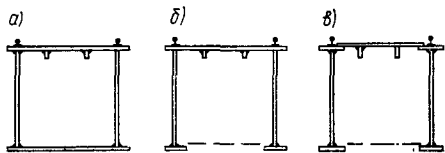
Сечения нижнего жесткого пояса подкраново-подстропильной конструкции
